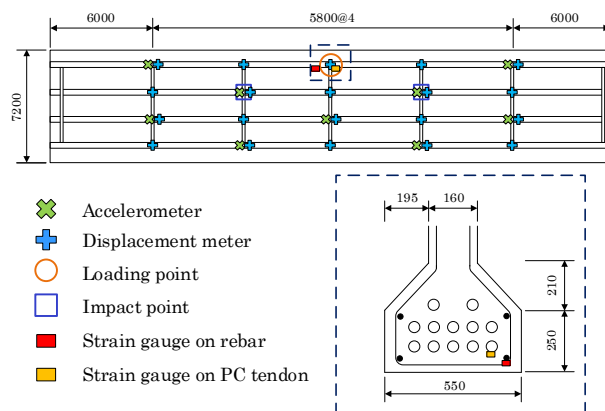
対象橋梁概要とセンサ配置図 (単位: mm)
